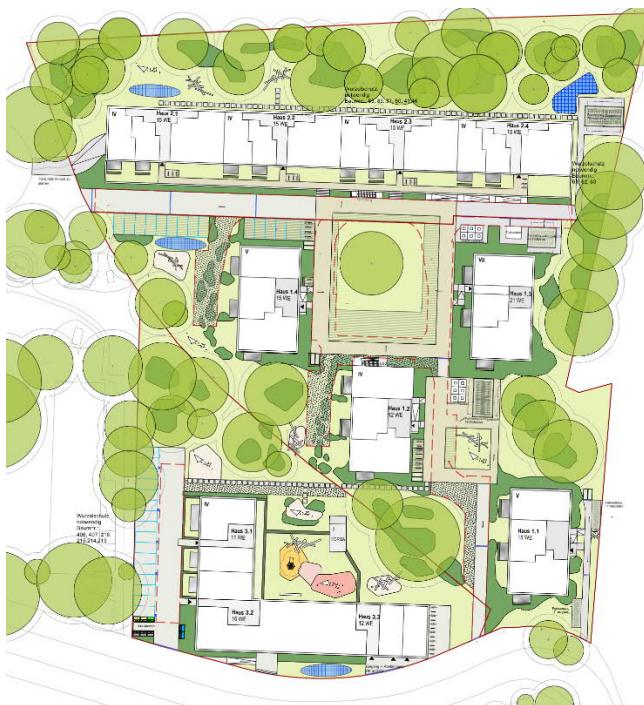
Lageplan der Grundstücke und der geplanten Wohnbebauung [07]
